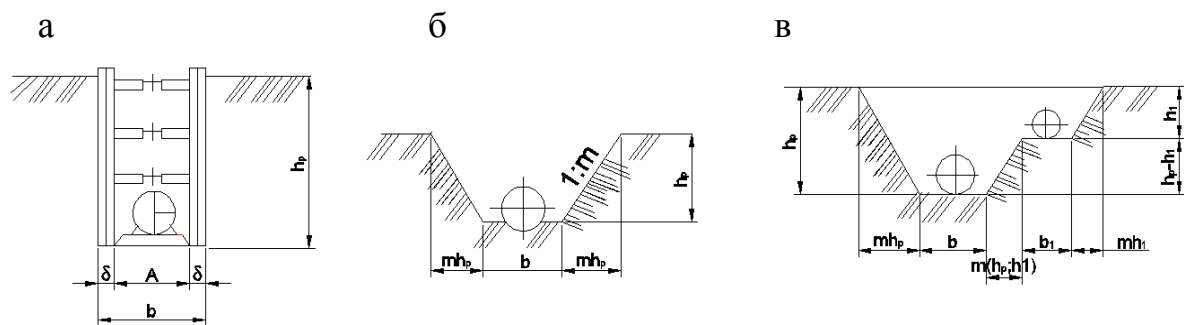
Схемы поперечных разрезов траншей под водопроводные трубы: а – траншей с вертикальными стенками и креплениями; б – трапециодальных; в – сложного сечения при совмещенной прокладке трубопроводов.
